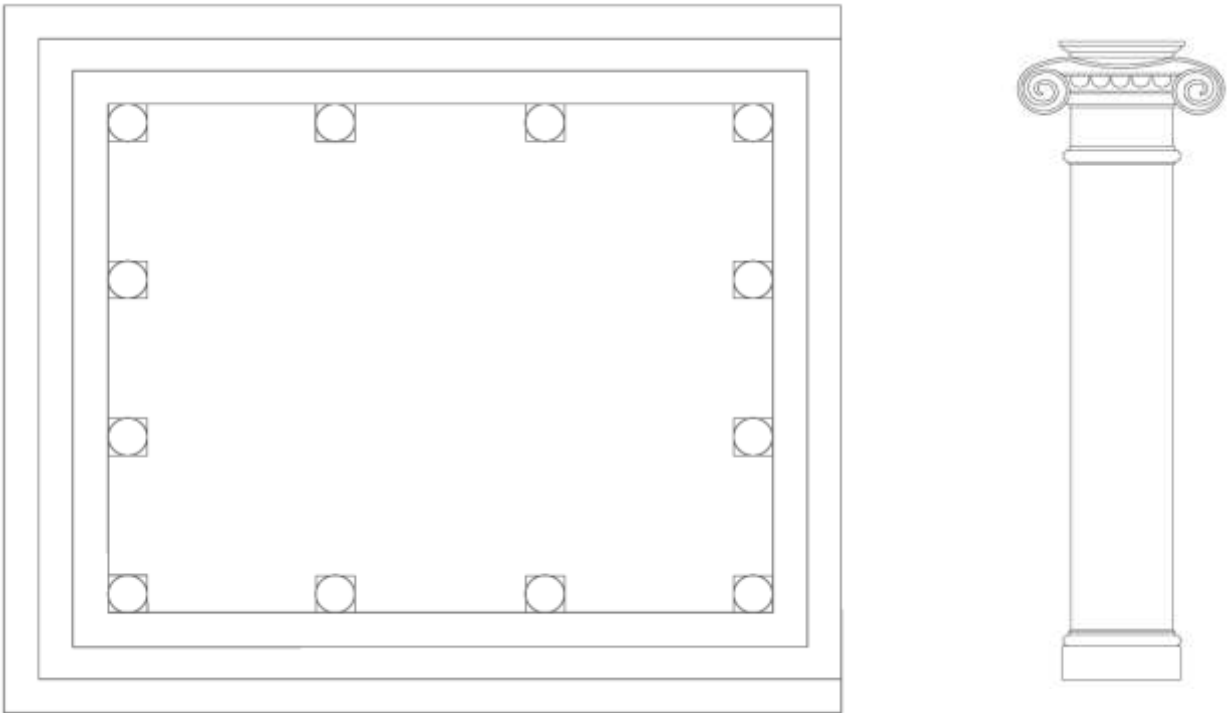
Planta y detalle de Columna del Templo de Minerva, Jalapa.
